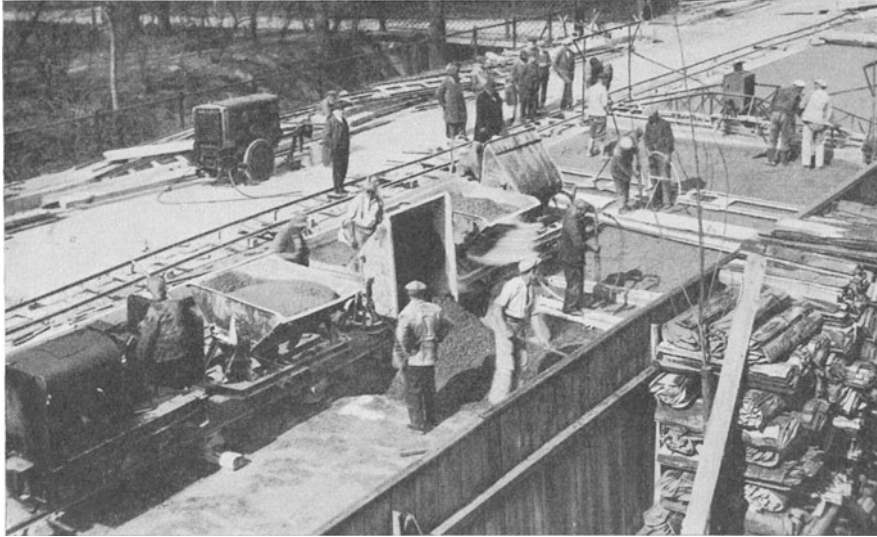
Baustelle einer zweischichtigen Betonstraße mit Anfuhr des Betongemisches, Preßluftstampfung des Unterbetons und Abgleichen des Oberbetons mit Straßenfertiger.
